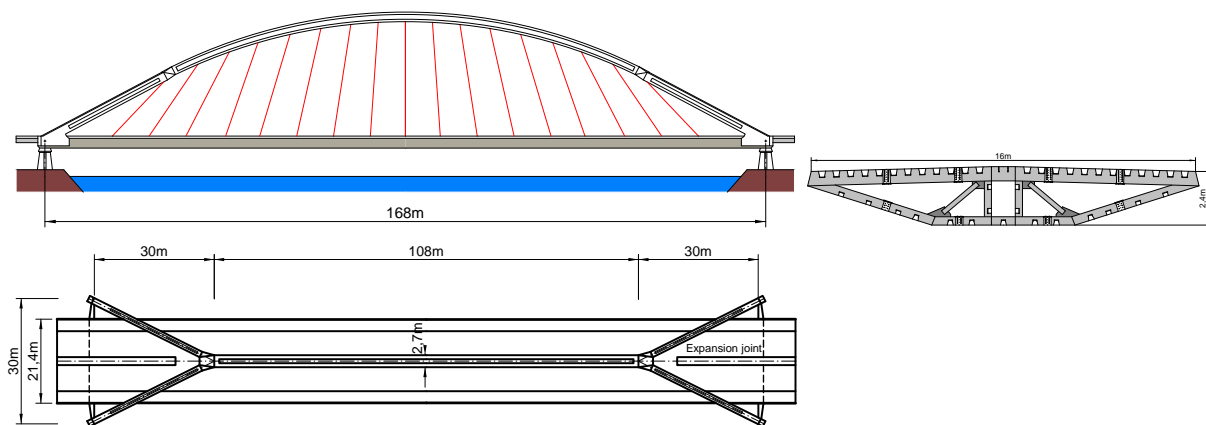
Alzado, planta y sección transversal de El Puente de la Barqueta.
